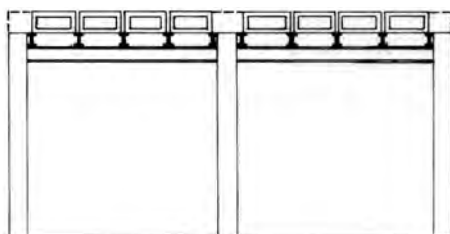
Corte demonstrando o sistema de suporte temporário. [FRAMPTON, 1979]:69d
